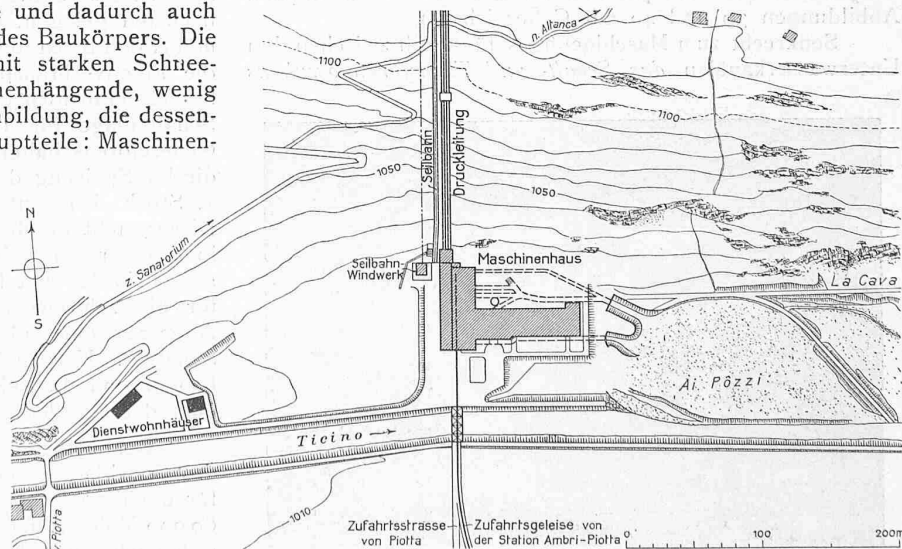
Lageplan des Maschinenhauses des Kraftwerkes Ritom. — Masstab 1:5000.
